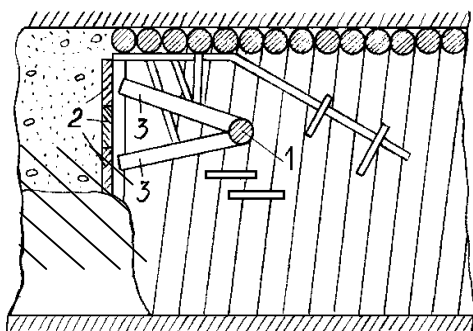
Поперечное сечение заходки (штрека) с лобовой маскировкой:
